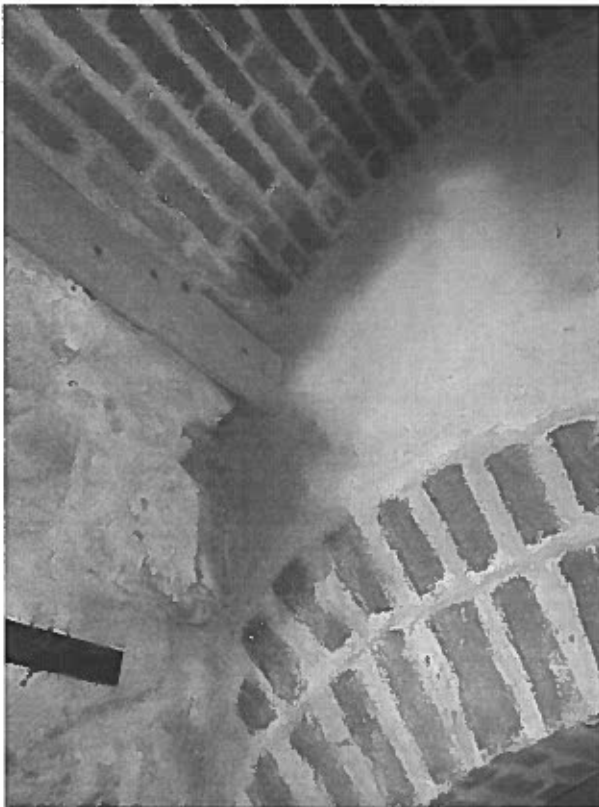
FOTO ZONA INTRARE – infiltratii la bolta – detaliu
